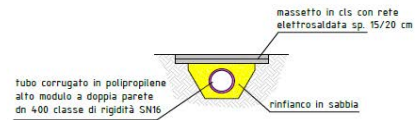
Tipologia di attraversamento stradale e cavalcafosso in progetto
